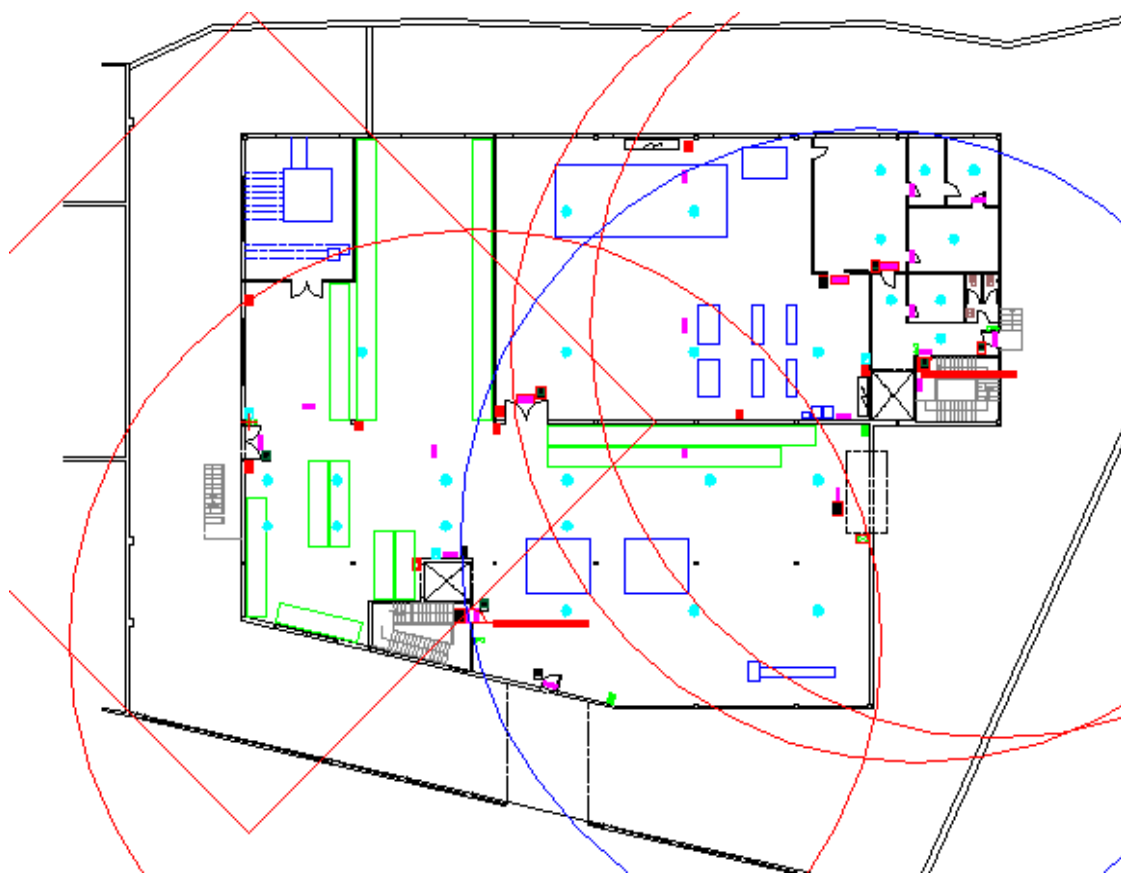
Superficie cubierta por los pulsadores en la planta baja del edificio Almacén
